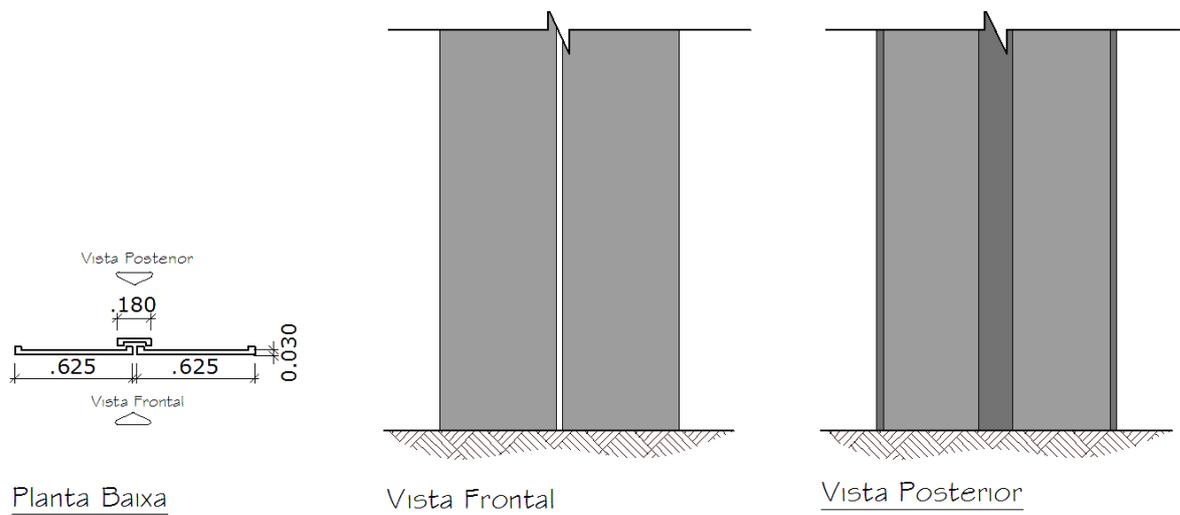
Parede Interna: Planta Baixa e Vista Frontal e Posterior.
